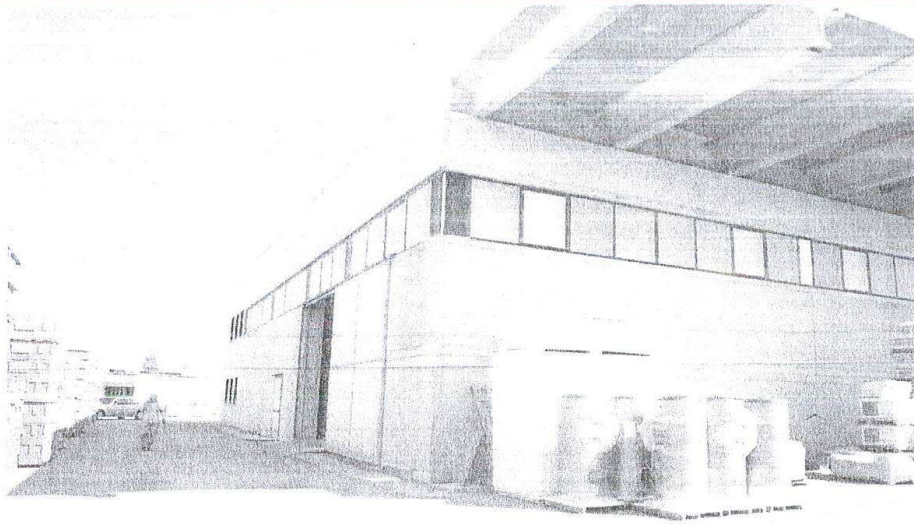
ingresso prospetto laterale lato di 30m con una parte della zona di stoccaggio blocchetti
